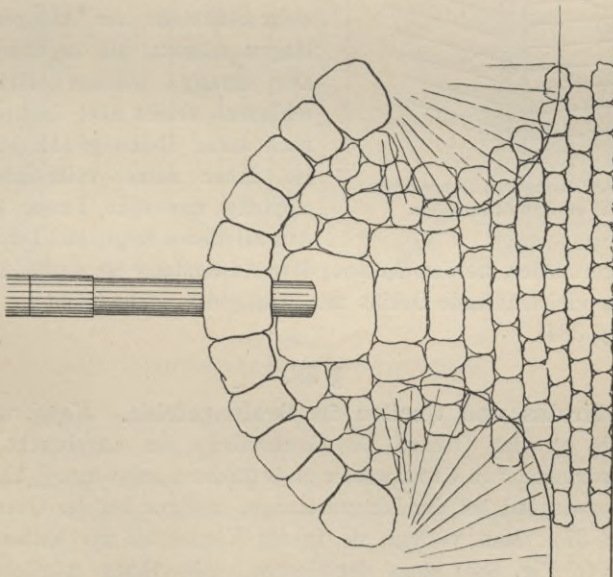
Ausmündung mit Vorbau. Grundriss.
